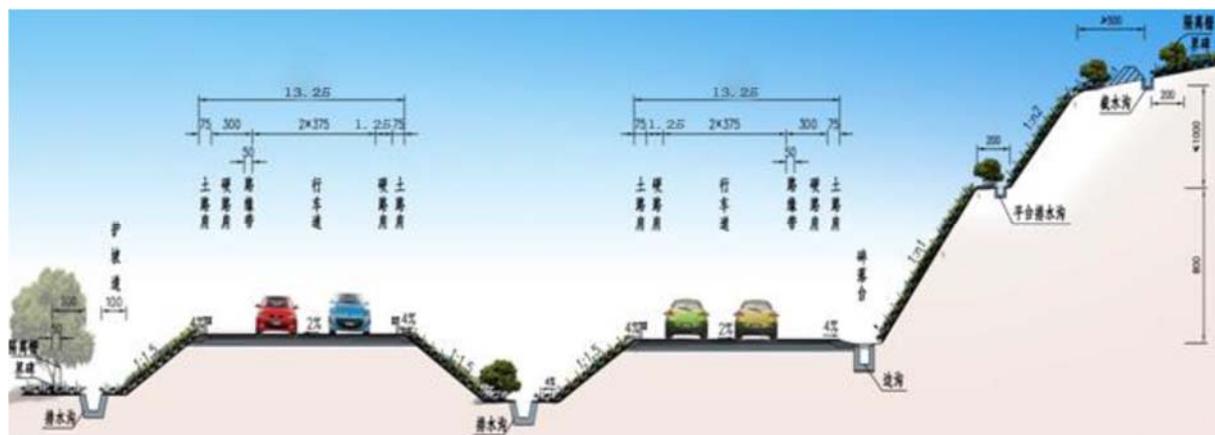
主线路基横断面图（路基宽 26.5m）
